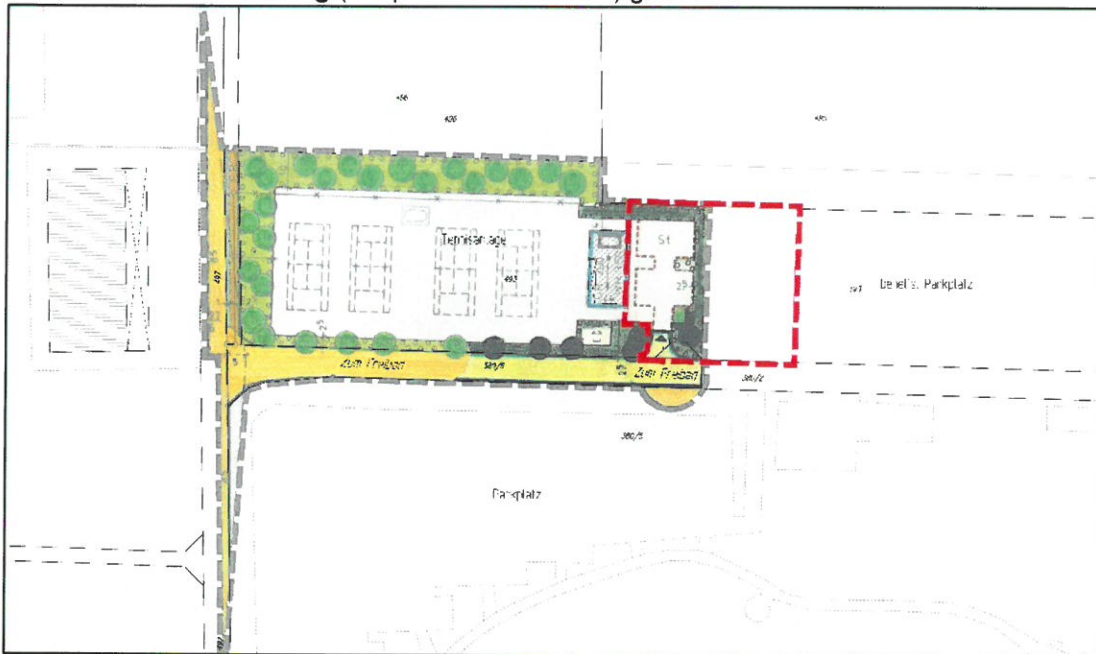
Rechtsverbindlicher Bebauungsplan mit der 1. Änderung
